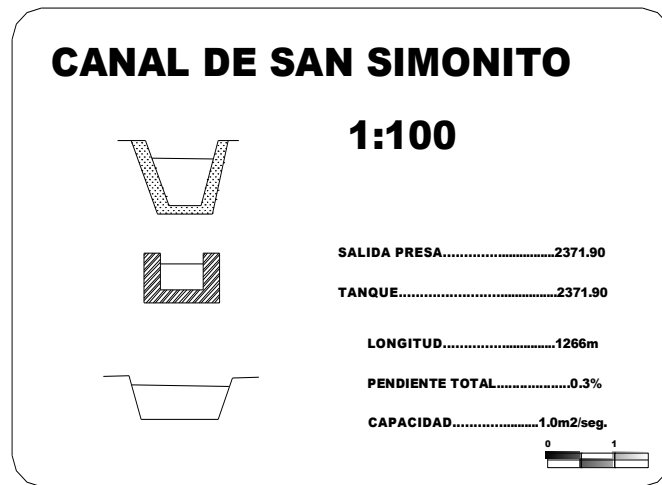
En esta imagen se muestra la construcción del canal de concreto y sus tapas,
